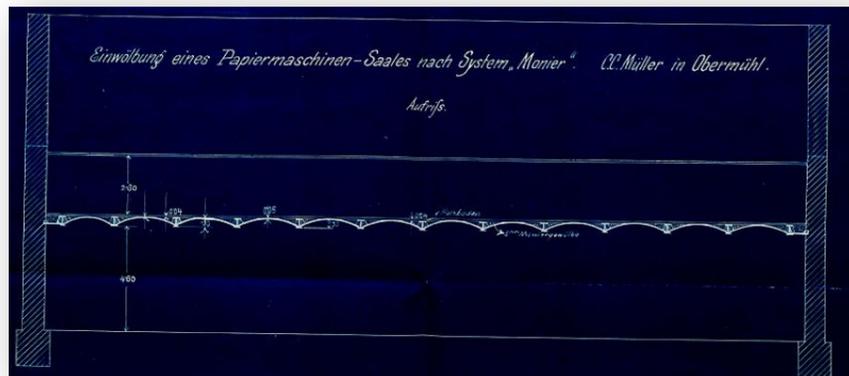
„Monier-Decke“ / Papiermaschinen-saal 1894
